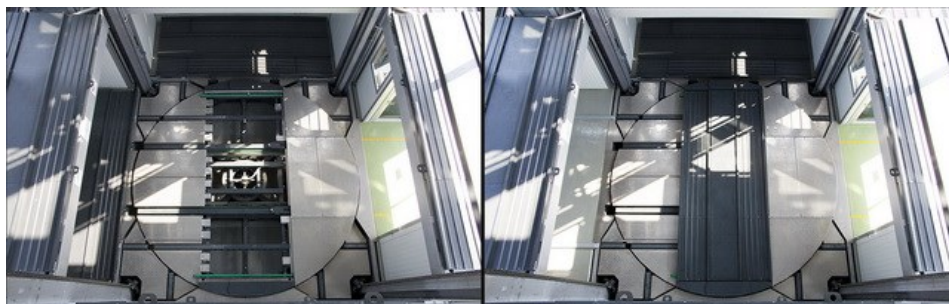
Зображення платформи підйомно-спускового механізму [5]
